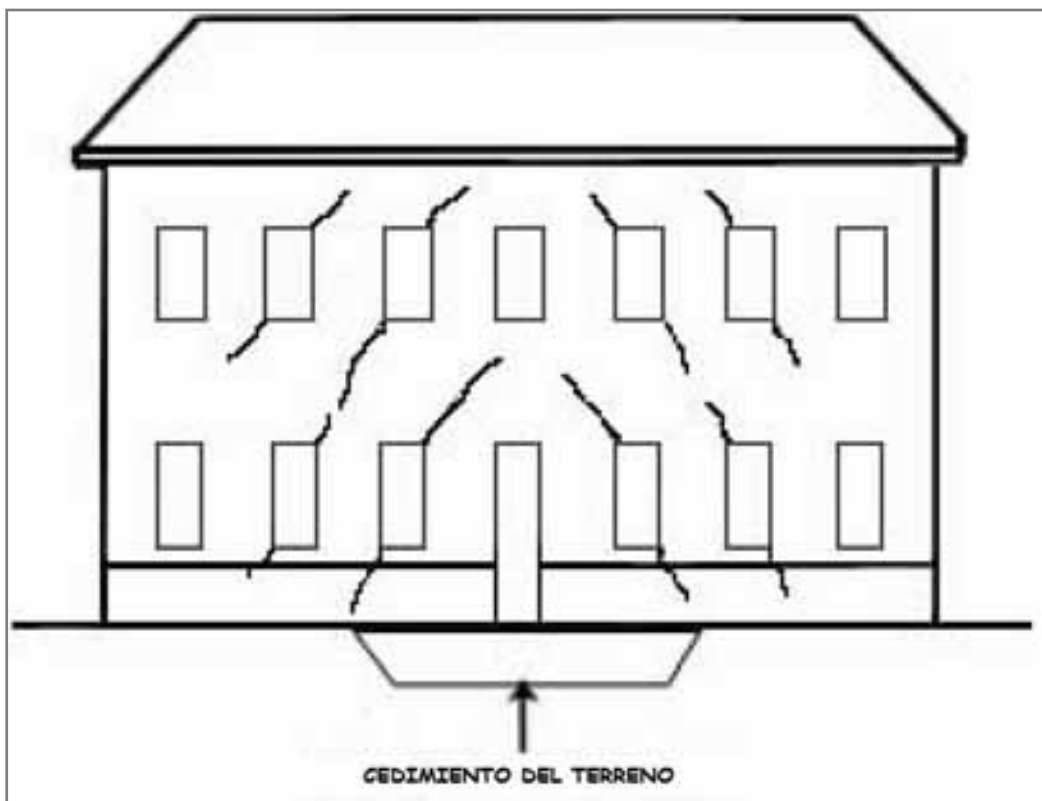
Grietas estructurales: Patología de la edificación (2008).
